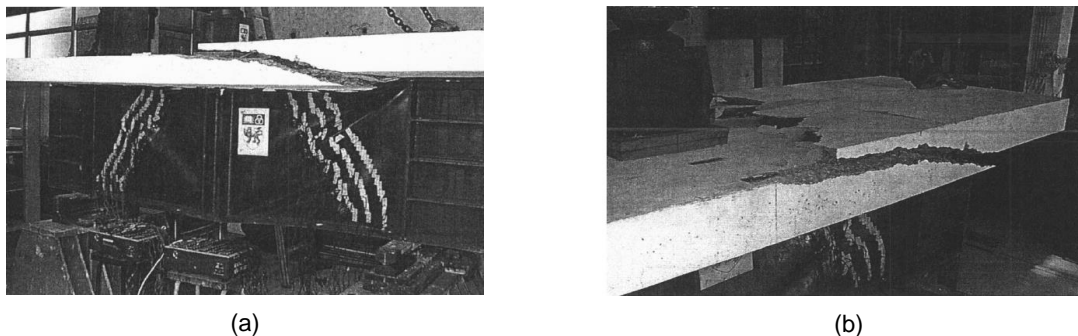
Aspeto final de uma viga testada no ensaio MI 2 [23]
